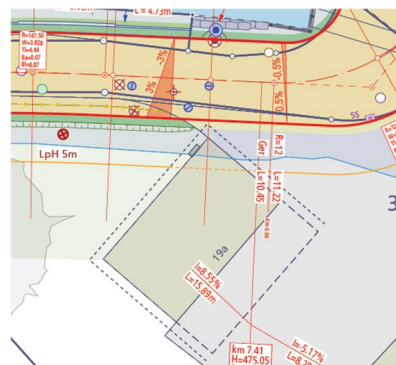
Wohnhaus inkl. Dachvorsprung, Sutter AG, Stand 04.09.2023
